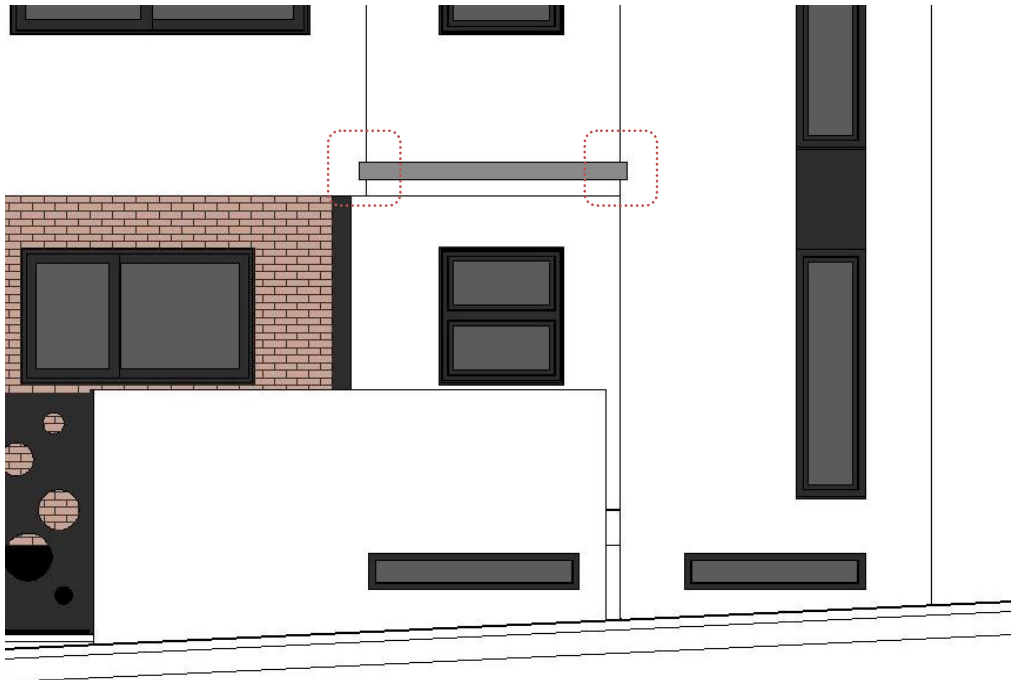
Voladizo del alzado del Proyecto en AutoCad. Fuente: .dwg Hadit Arquitectos
